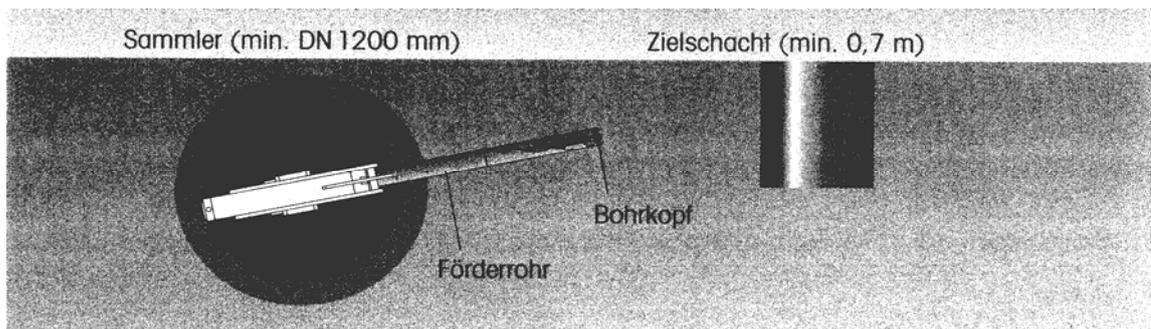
Pressen der Förderrohre mit Schnecke und Bohrkopf [1]
